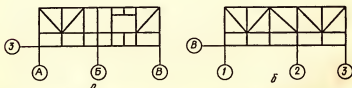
Схемы каркасов наружных стен вдоль осей 3(а) и В(б)
